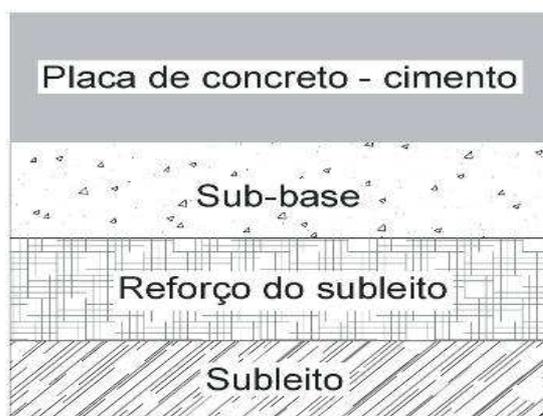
Esquema estrutural de um pavimento rígido.
